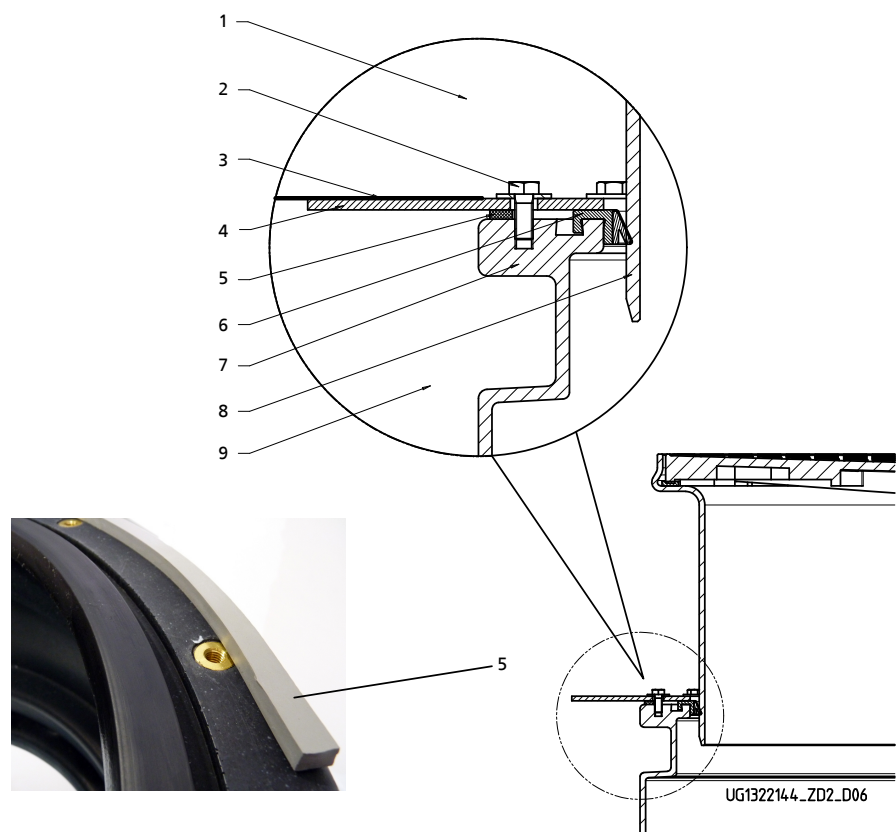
Aufbau mit Dichtungsflansch DF 630
